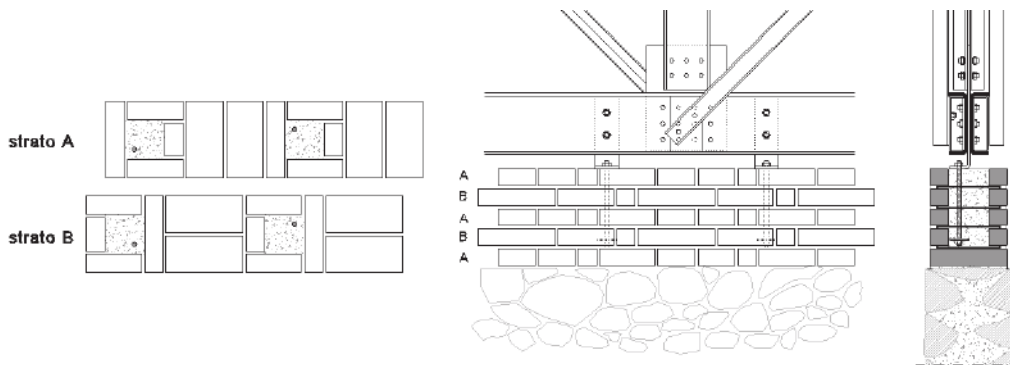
Pianta dei corsi, prospetto e sezione trasversale del cordolo in muratura con collegamenti puntuali
